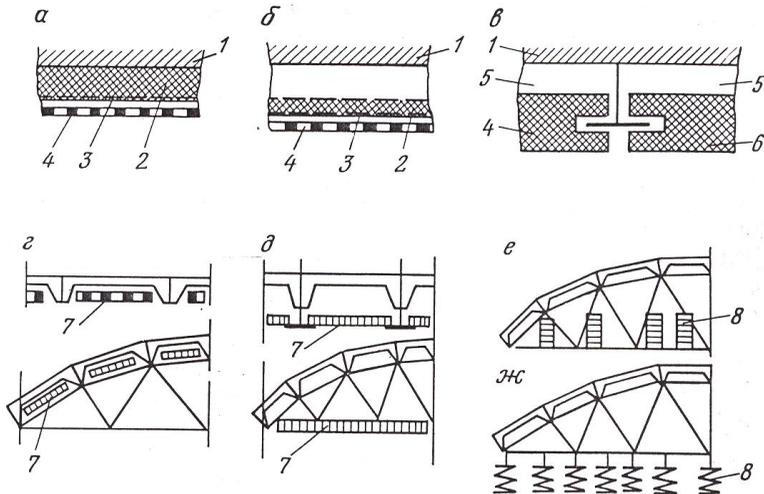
Схемы размещения звукопоглощающих облицовок на потолках помещений: а — без воздушного зазора; б — с воздушным зазором; в — с использованием плит из звукопоглощающего материала; г — в плитах перекрытия; д — в виде подвесного потолка; е — в межферменном пространстве; ж — под нижним поясом ферм; 1 - защитная конструкция; 2 - защитная оболочка; 3 - звукопоглощающий материал; 4 - потолок или стена; 5 - воздушный промежуток; 6 - плита из звукопоглощающего материала; 7 - звукопоглощающие щиты; 8 - акустические балки
